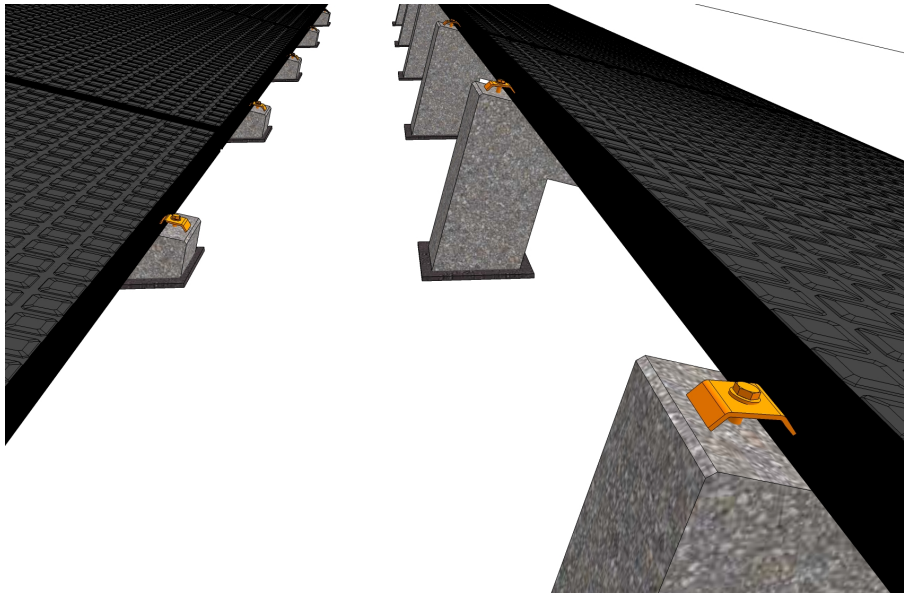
Befestigung der Kollektoren an die Betonsockel mit Hilfe der Edelstahlplättchen und -schrauben.
